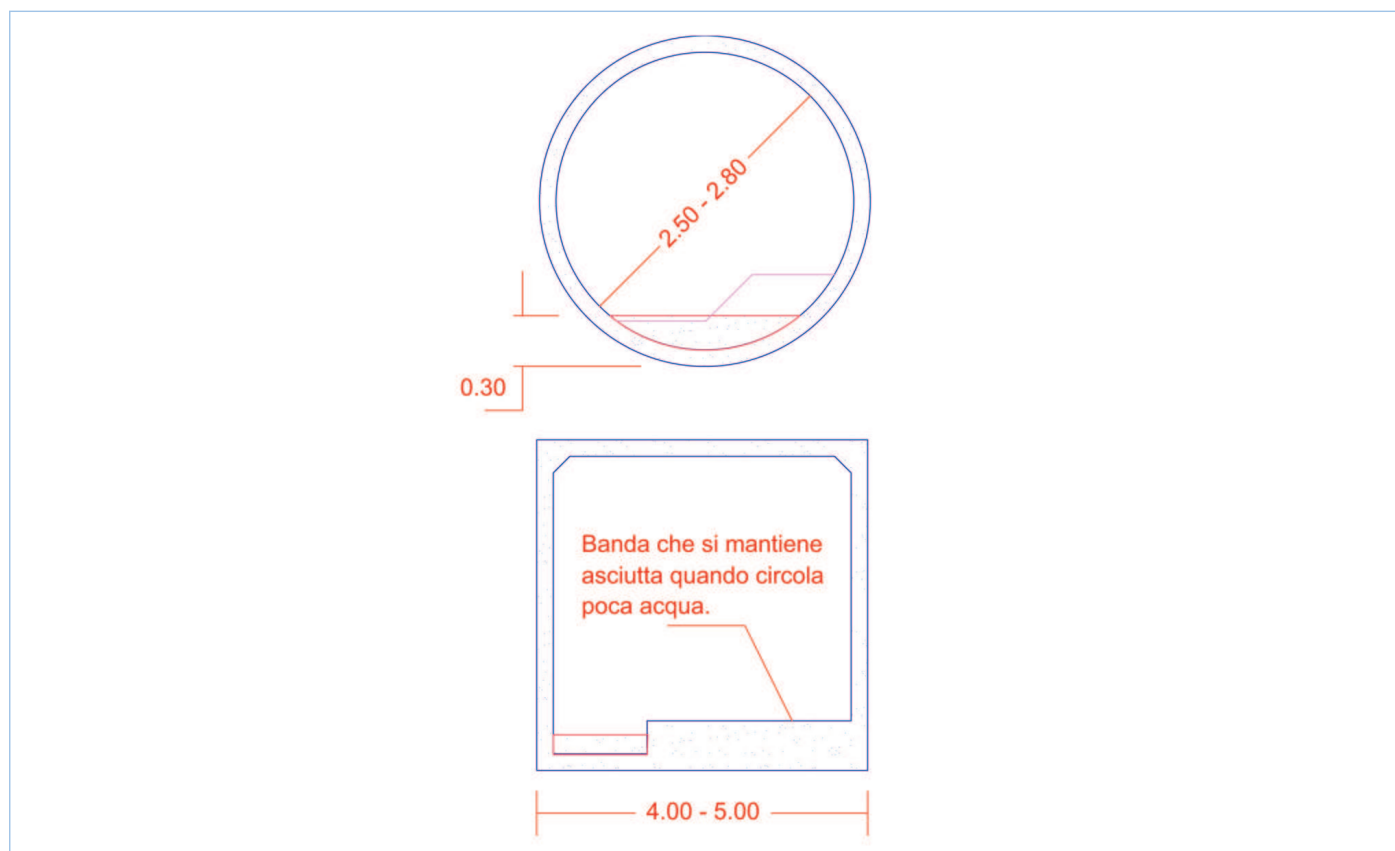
Adattamento di tombini di drenaggio e scatolari idraulici per il passaggio della fauna (tratto da Rivella – UTET Scienze Tecniche)
